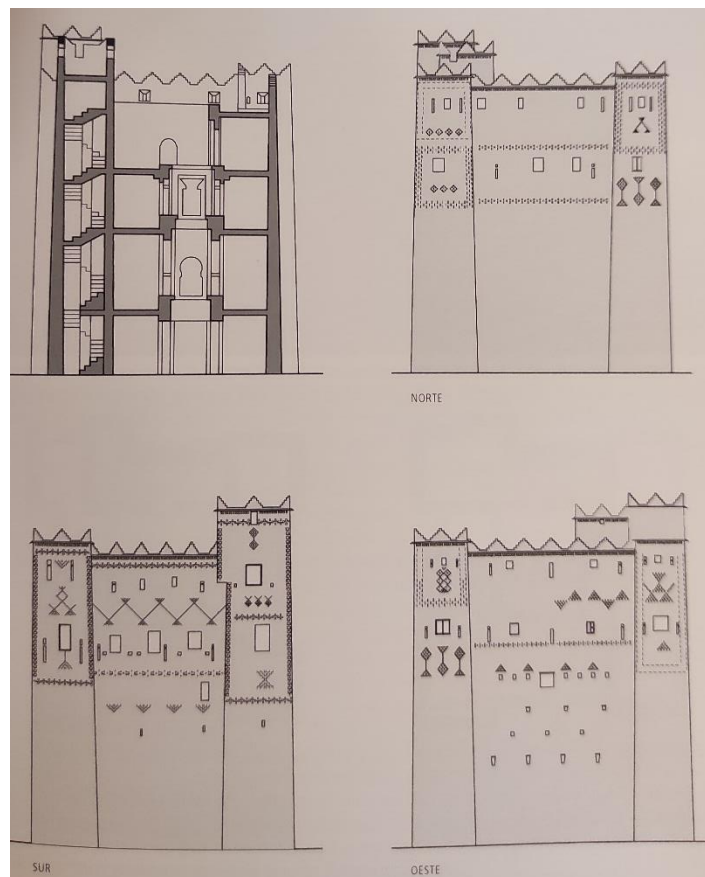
Sección y Alzados Norte, Sur y Oeste de Ait Abou.
